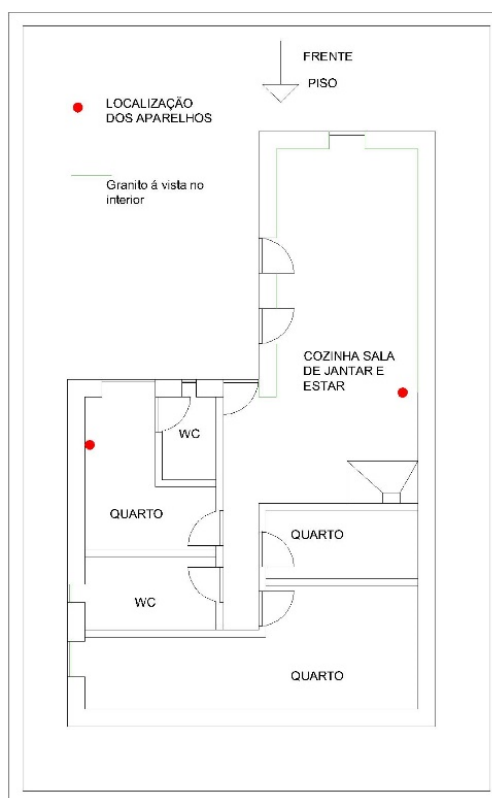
Planta de Apresentação de Piso, Amostra D (sem escala)
